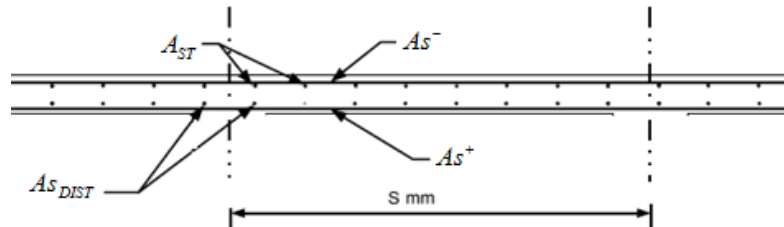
Armado de los vanos interiores del tablero (corte transversal)
